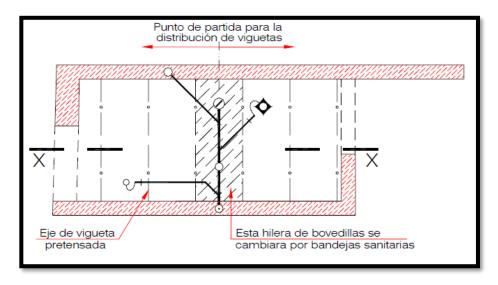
Detalle de las instalaciones sanitarias en el sistema tipo Firth parte II.
